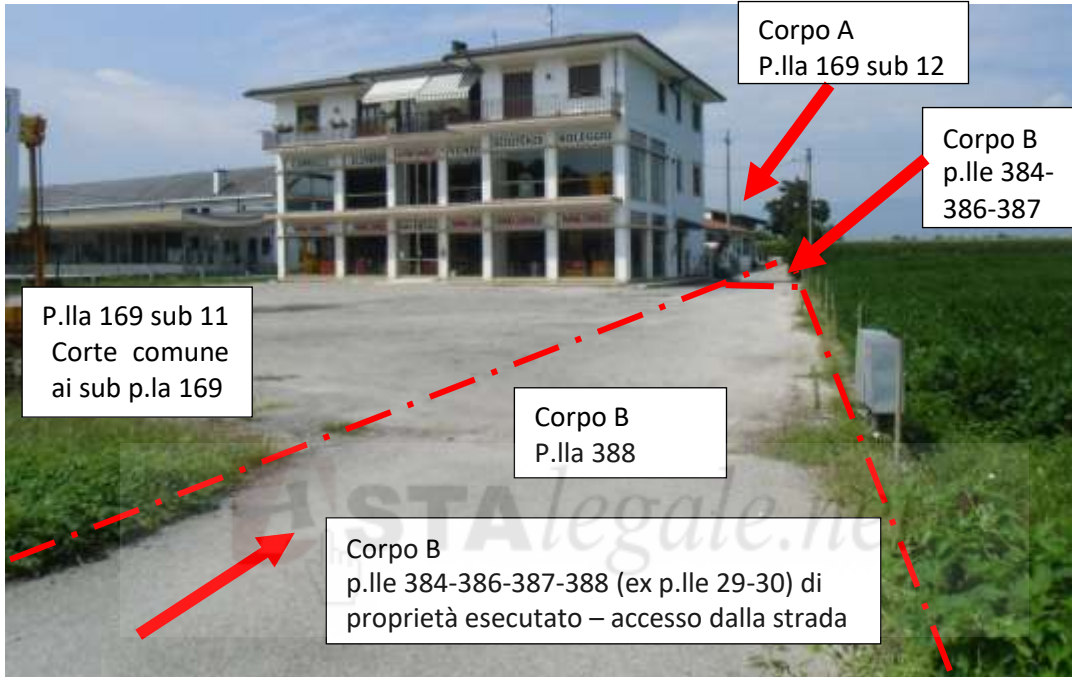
1b-2; accesso da sud da SP46 - Via Vicenza n. 73 e vista lato Est
